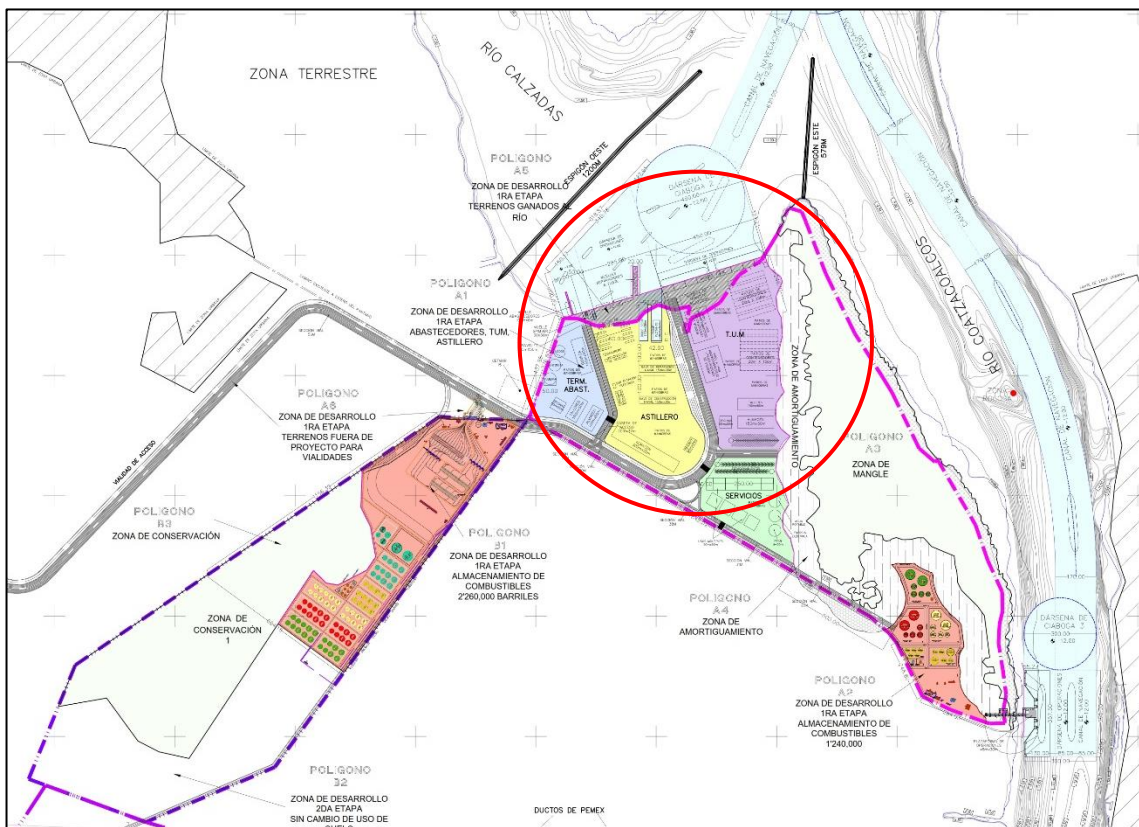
Plan maestro general, Etapa Preparación del Sitio Terminal SPIMVER
